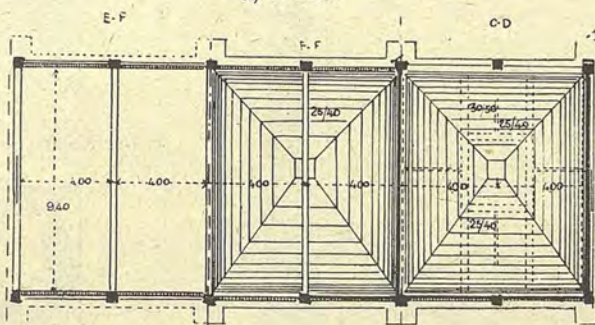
a, b, c.* — Silos con celle in una sola fila a sezione rettangolare.
